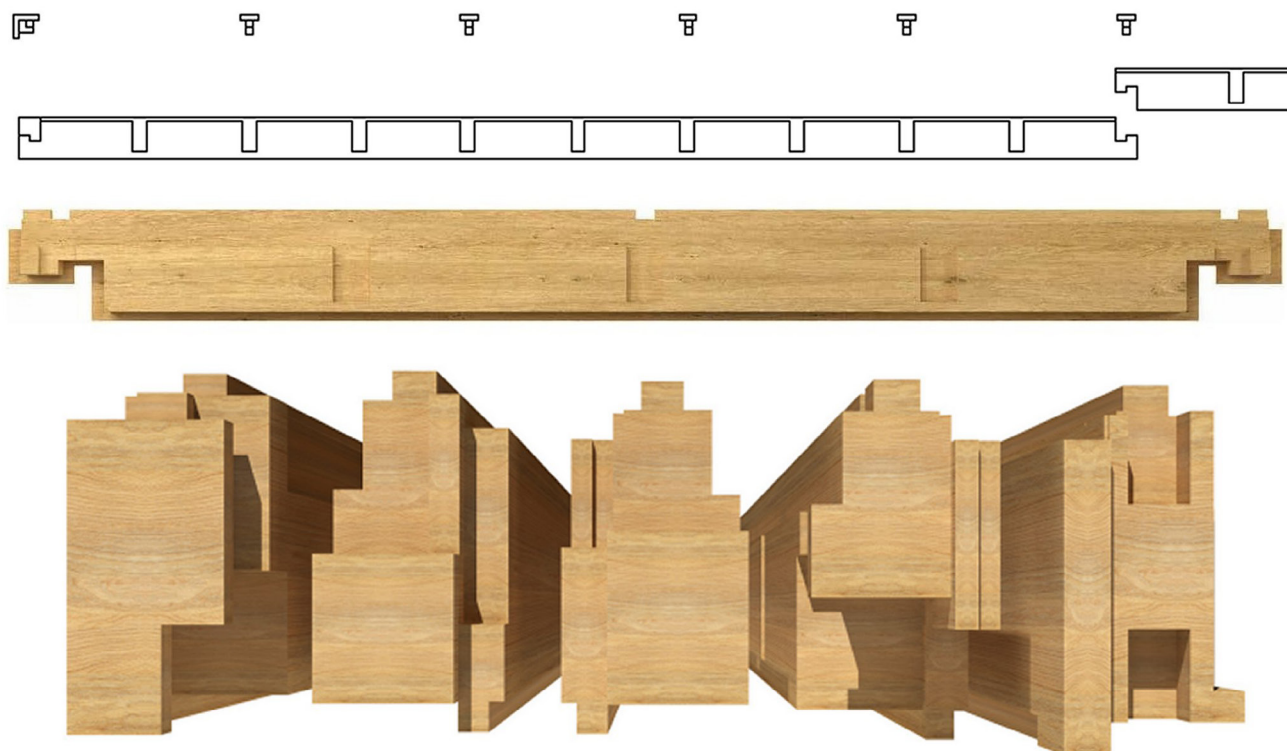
Tramo típico de viga El mecanizado extremo permite el empalme de vigas entre sí.
